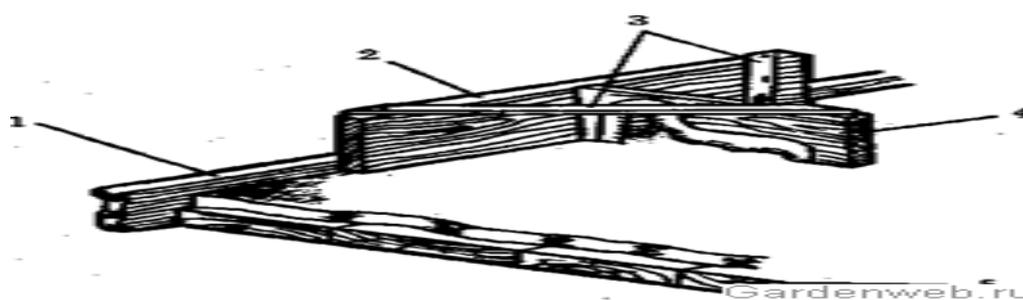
Шаблон для вытягивания прямолинейной гипсовой тяги Карниза: 1 — направляющая рейка верстака; 2 — полозок; 3 — планки; 4 — шаблон; 5 — верстак
